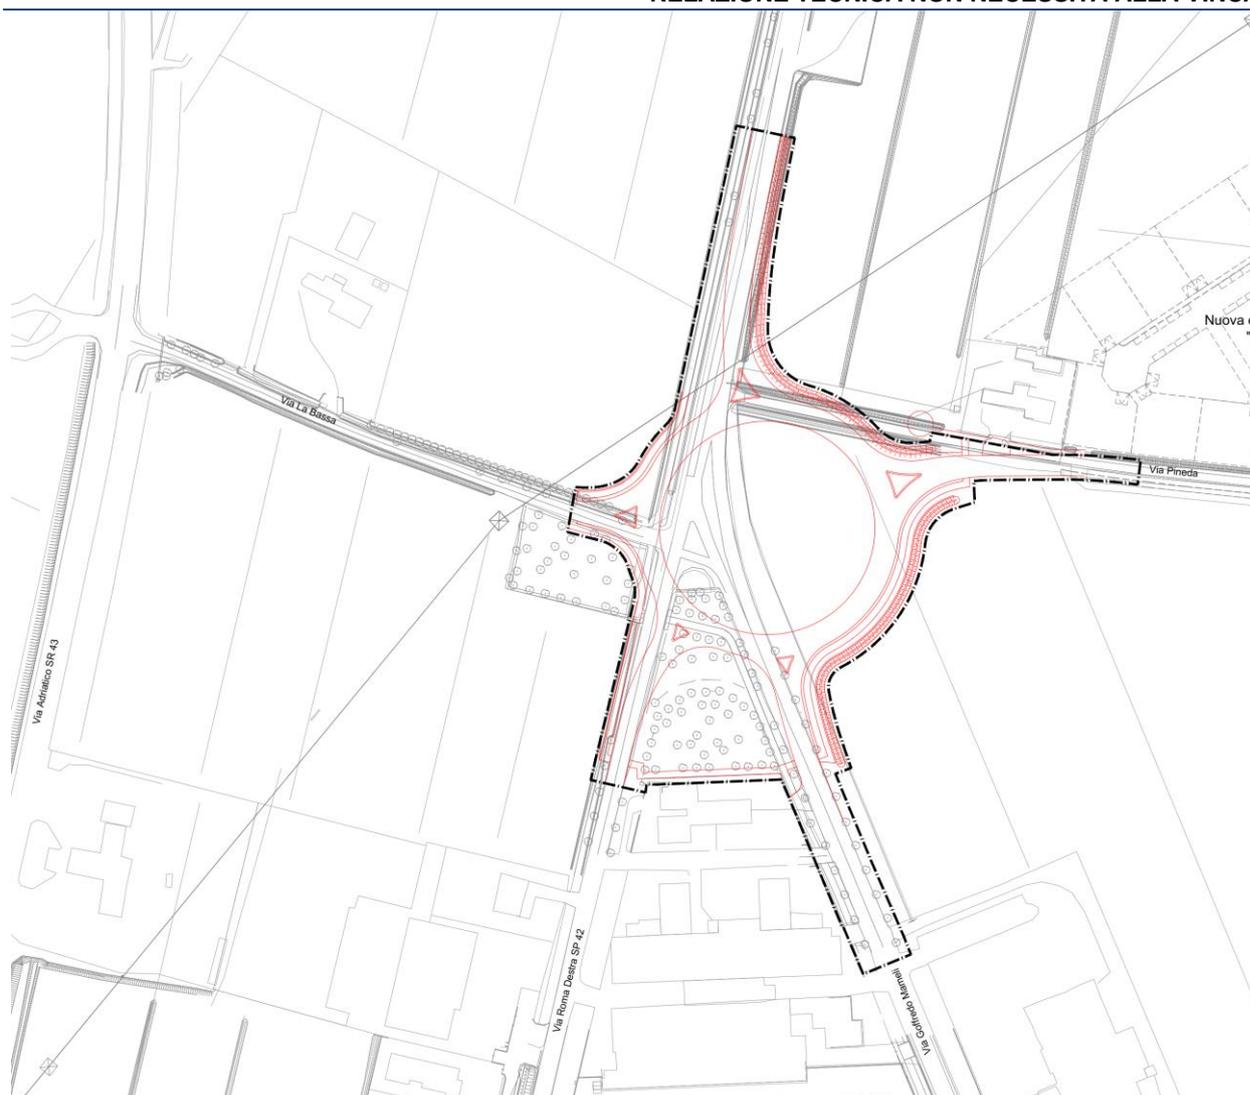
Estratto della planimetria di sovrapposizione tra stato di fatto e di stato di progetto (in rosso).
